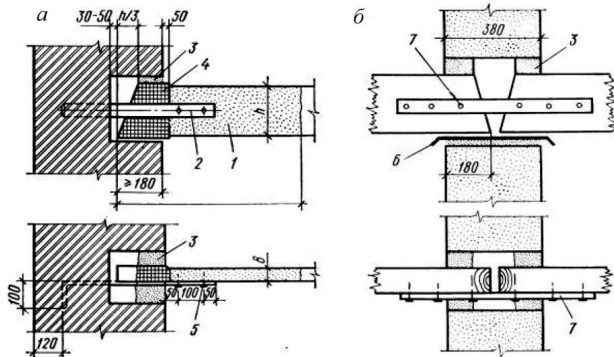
Опирання дерев'яних балок на кам'яні стіни:
